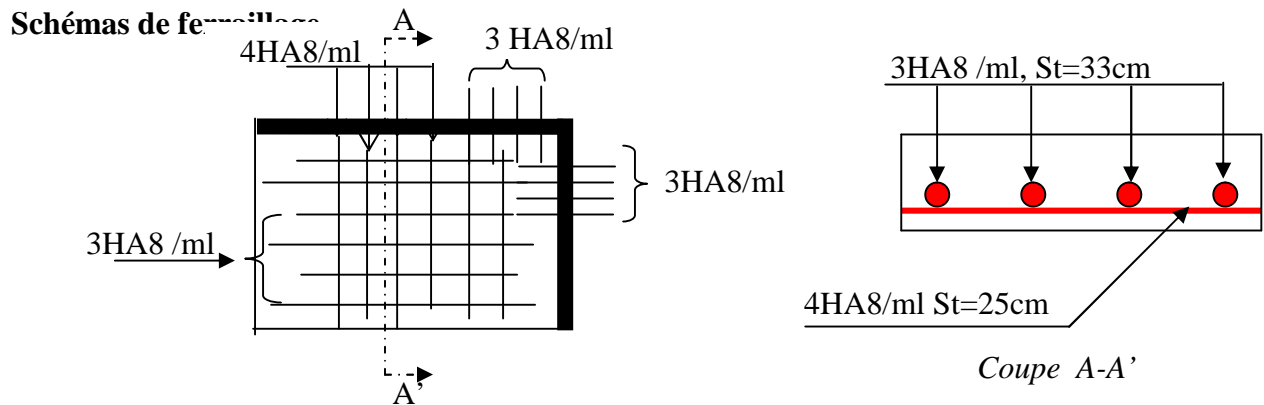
Schéma du ferrailage du balcon sur deux appuis
